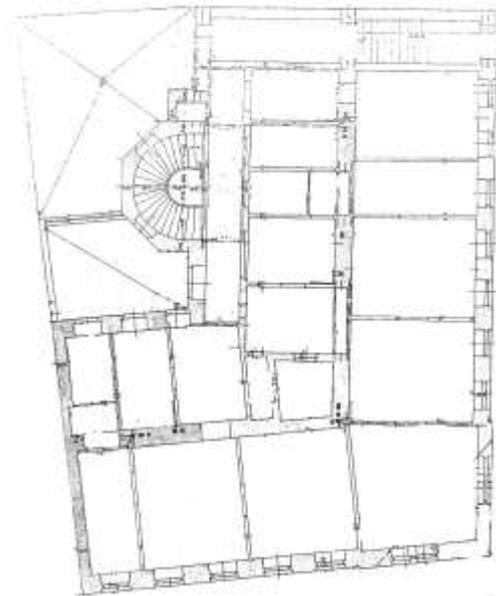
Grundriss Urban Loritz Platz 1
